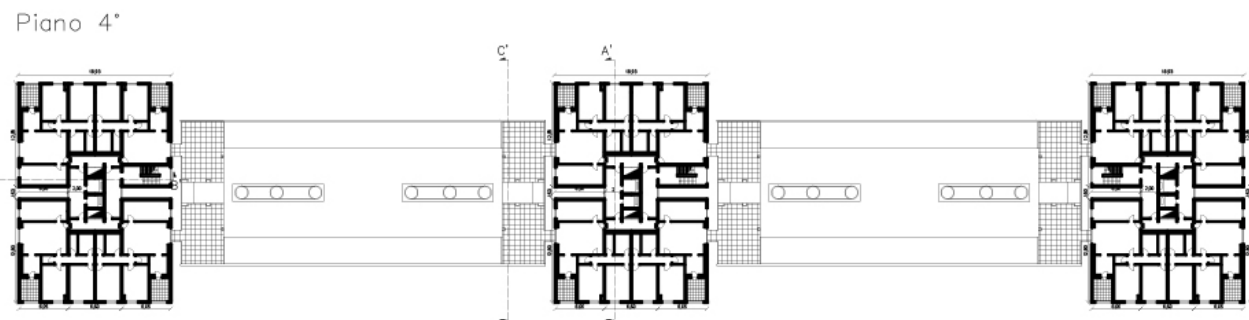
Comparto M4, planimetria del piano tipo delle torri
